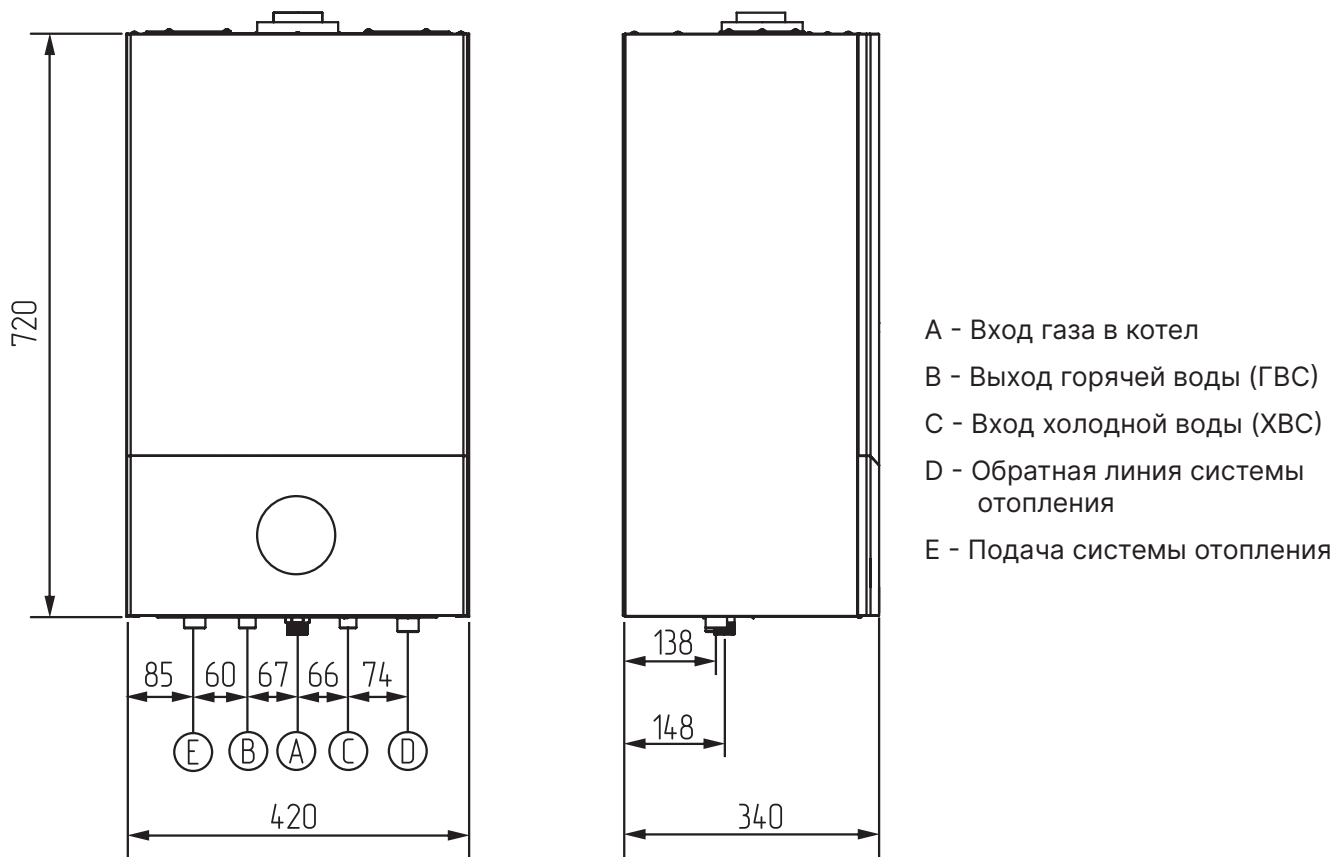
Габаритные размеры и обозначения котла ZOTA PLASMA 32D
